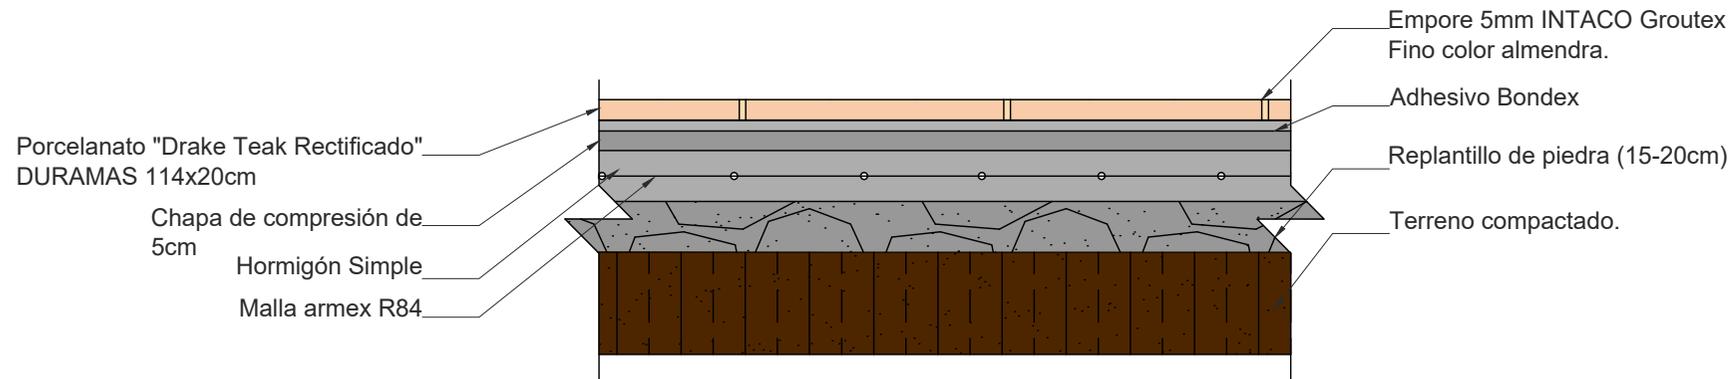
Detalle y Subdetalles constructivos en común de los cortes.
